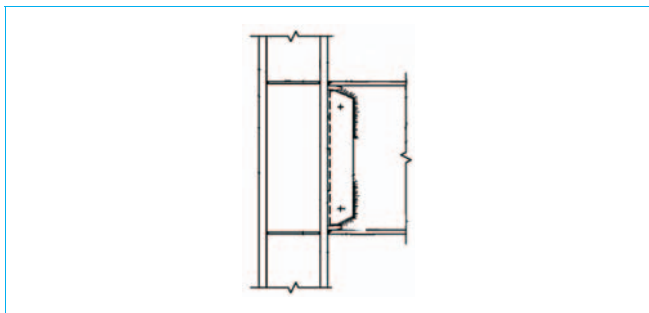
Assemblage poutre/poteau soudé (via gousset pour l'âme) (d'après la norme FEMA 350, cf. [Doc. C 2 559])
